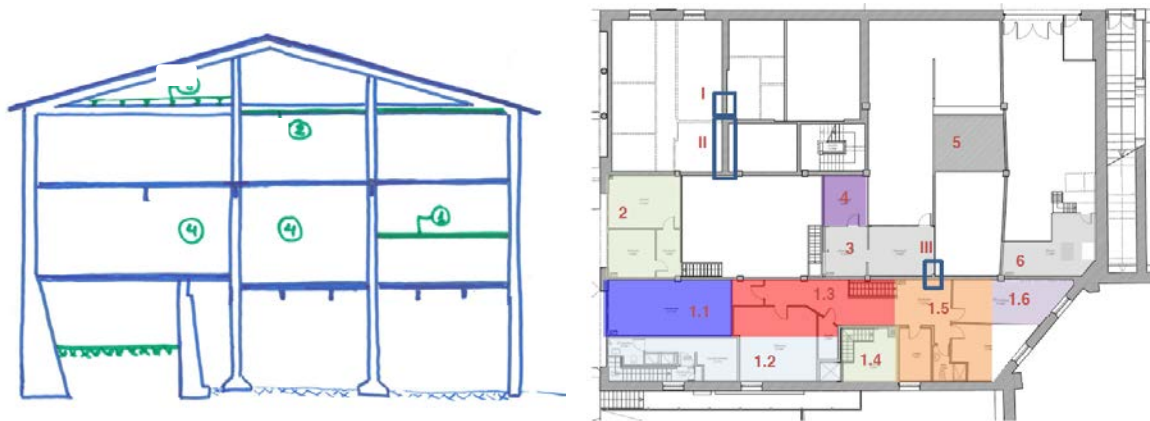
a) Esquema simplificado, en azul la estructura original y en verde las nuevas; b) entreplantas entre las plantas baja y primera originales
